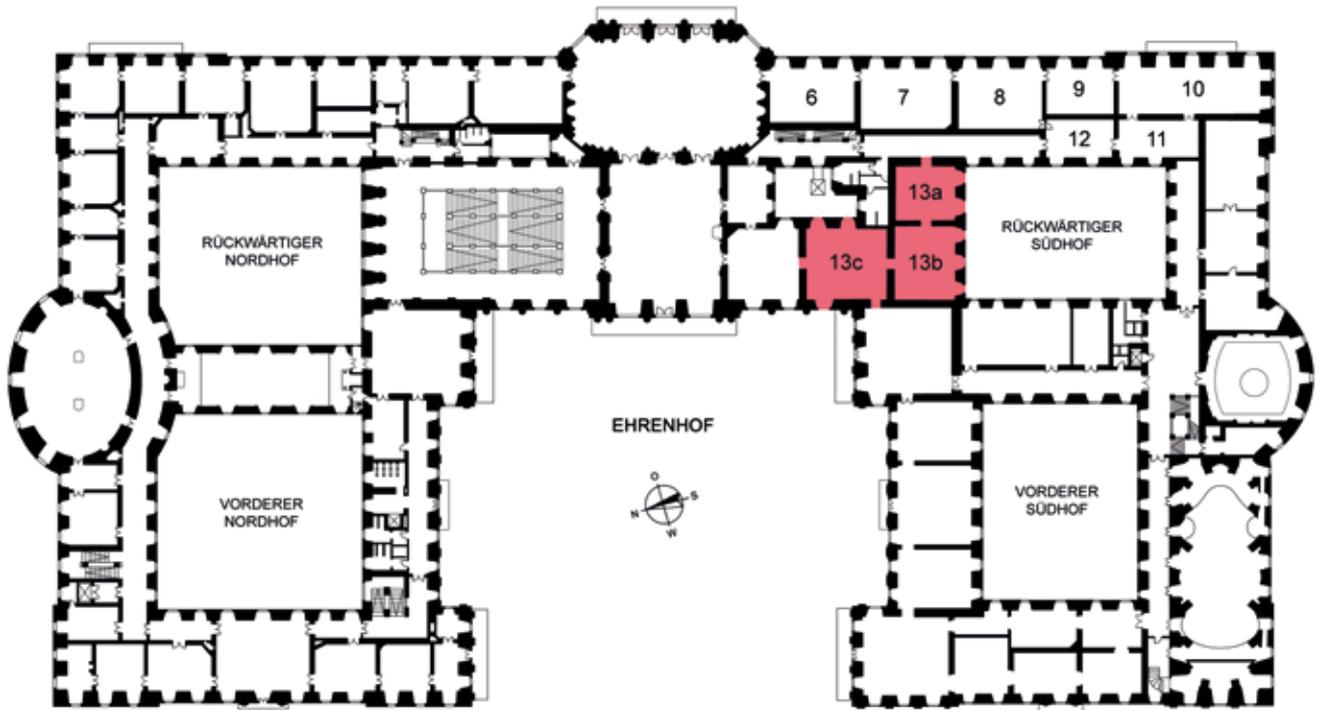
Grundriss der Residenz Würzburg, 1. OG nach dem Wiederaufbau (Plan Bayerische Schlösserverwaltung, W. Schott)
